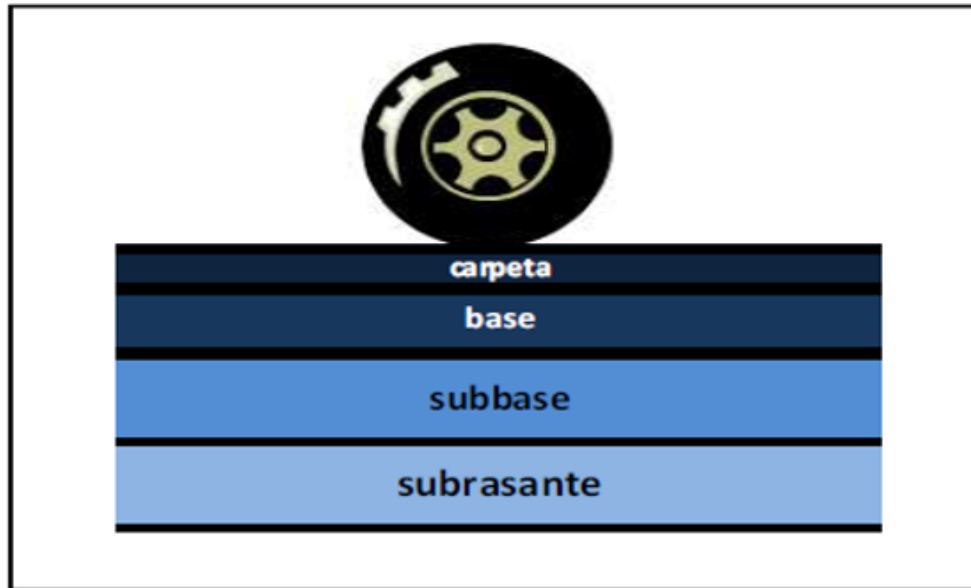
Imagen Capas de un Pavimento Rígido.
